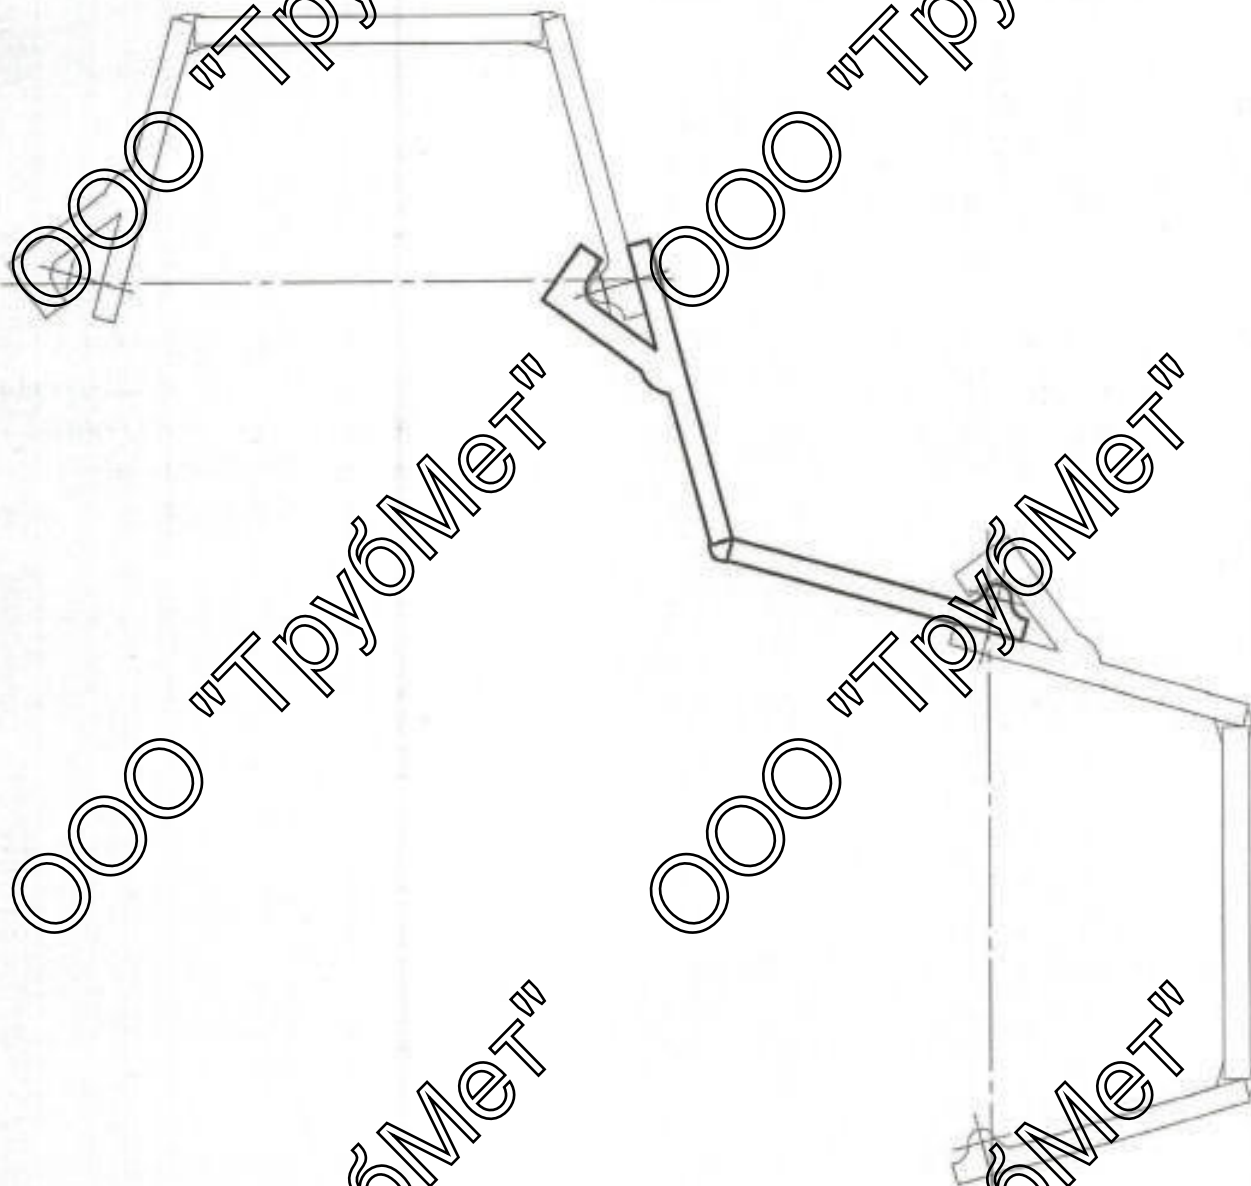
Схема поворота шпунтовой стены на заданный угол путём использования угловых профилей СШКу
